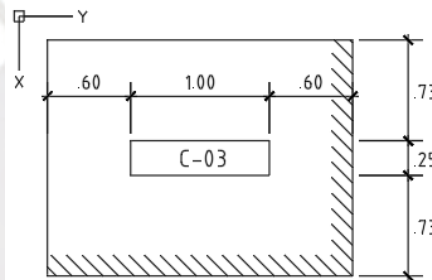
Dimensiones de la zapata de la columna D/8 (C-03).
